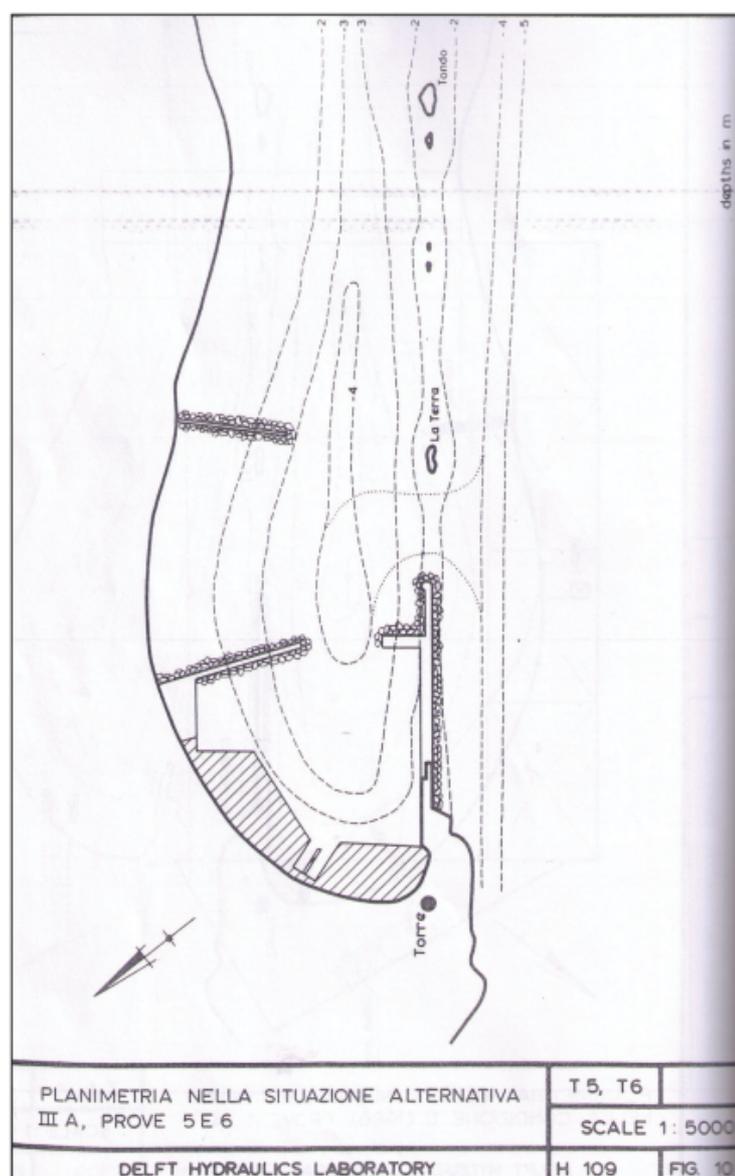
Planimetria denominata III A estratta dal rapporto sulle prove curato dal Laboratorio di idraulica DHL di DELFT. Prove su modello idraulico tridimensionale della penetrazione delle onde nella situazione IIIA.
